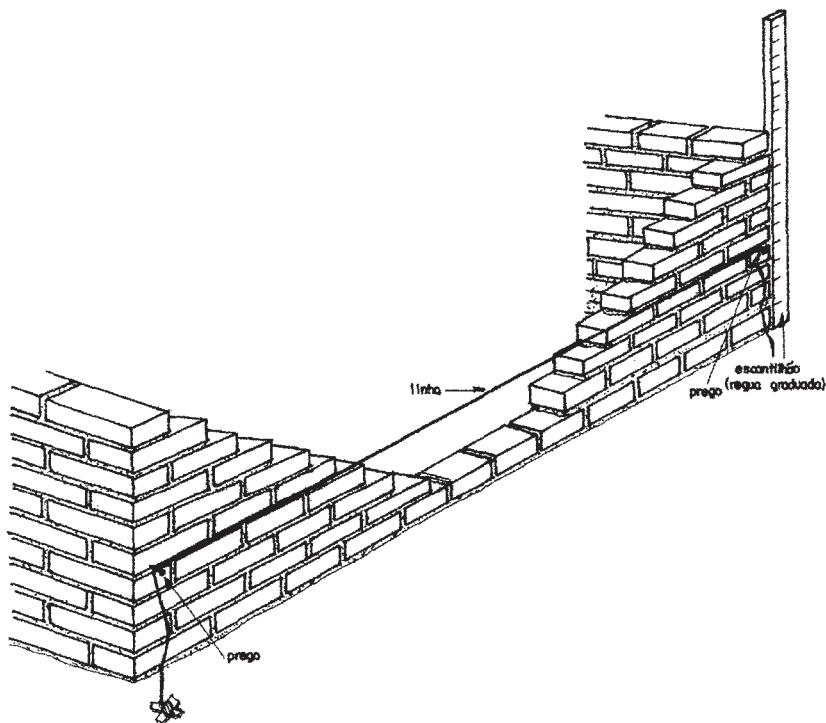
Detalhe do nivelamento da elevação da alvenaria.
